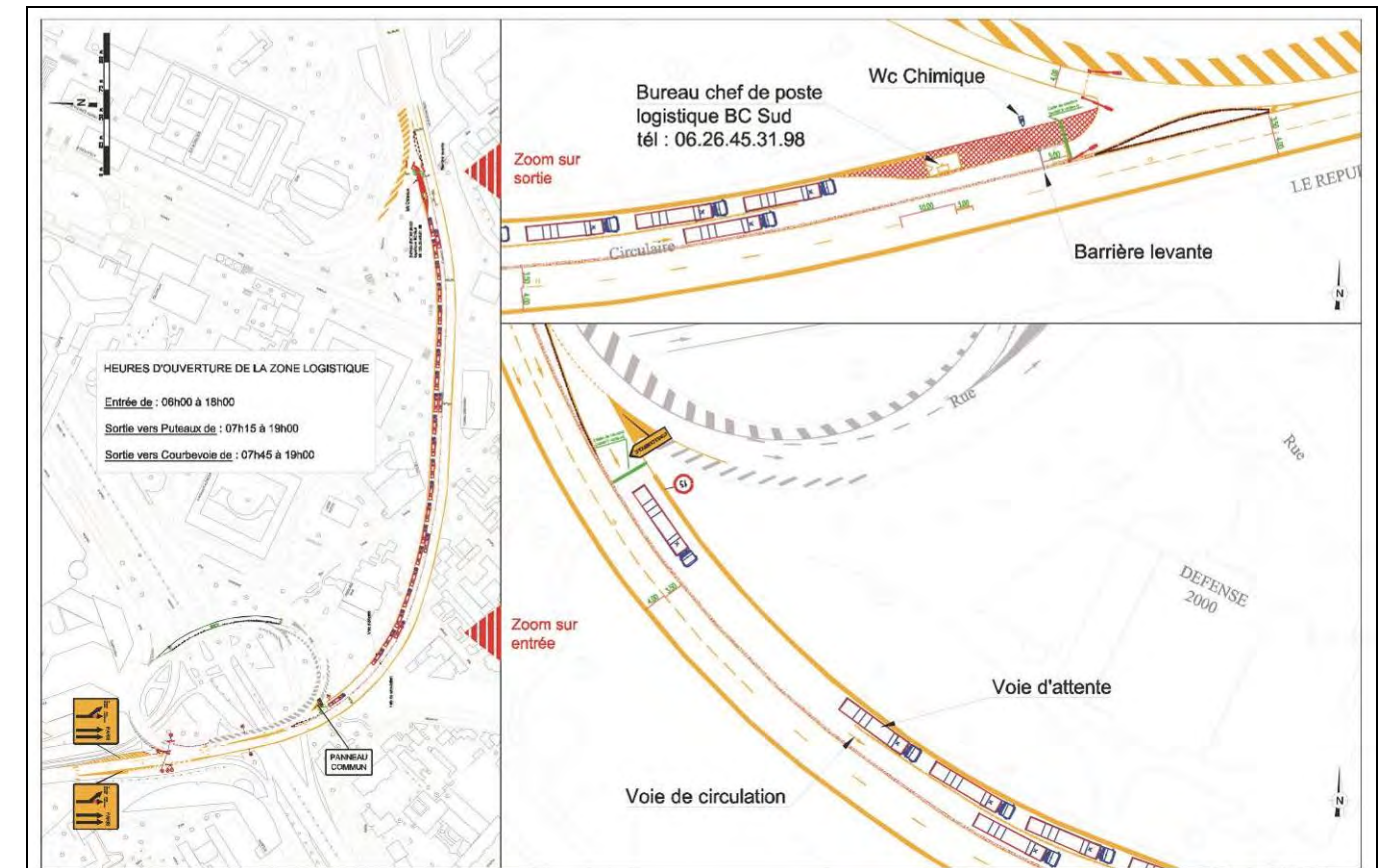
Plan de la zone logistique du boulevard Circulaire Sud
